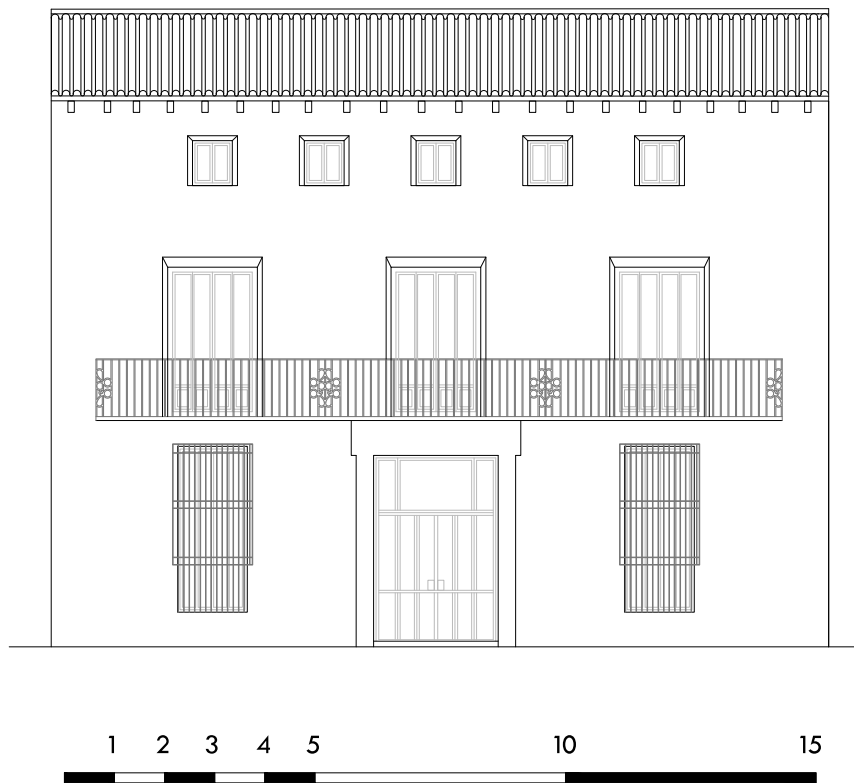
Fachada de la casa n.º 12 de la calle Sants.
